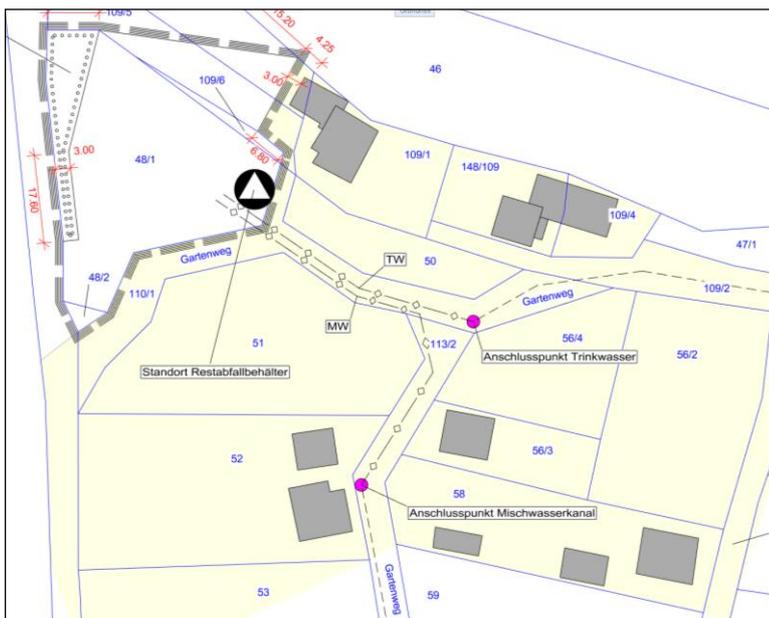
Anschlusspunkte Trinkwasserleitung u. Mischwasserkanal (Quelle: GEWAS)
